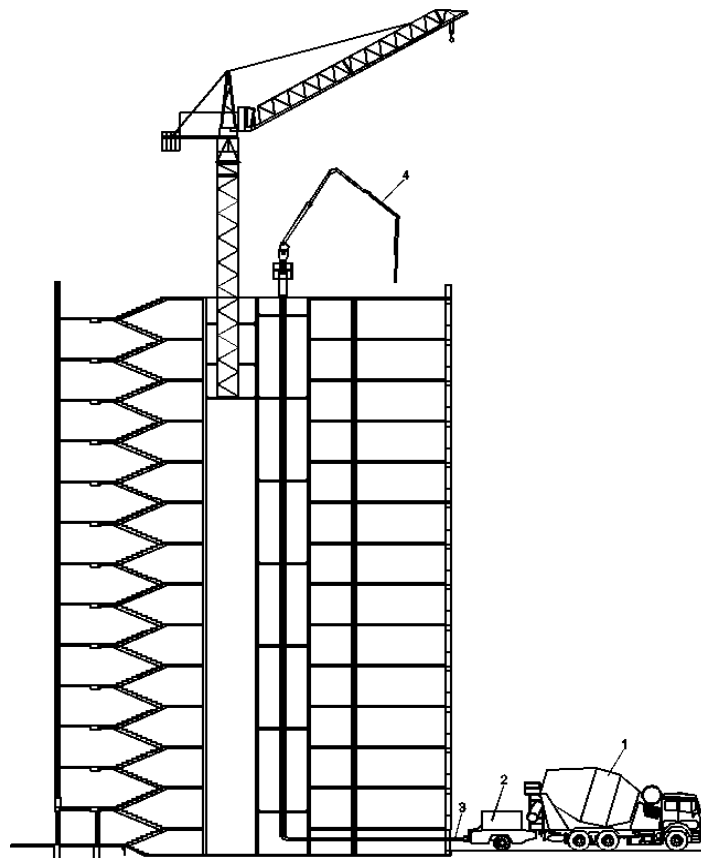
Схема подачі бетонної суміші бетононасосом:
